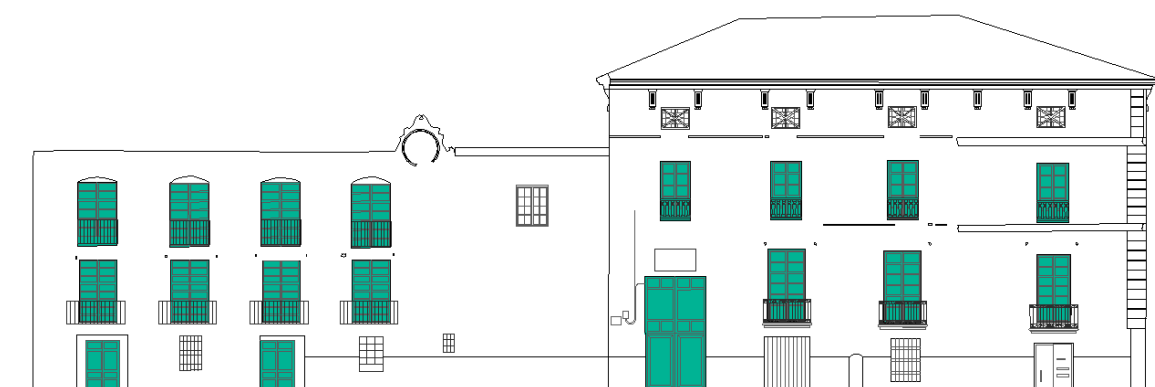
Elementos con una conservación total. Fachada Plaça Poble Nou. Fuente: Elaboración propia
